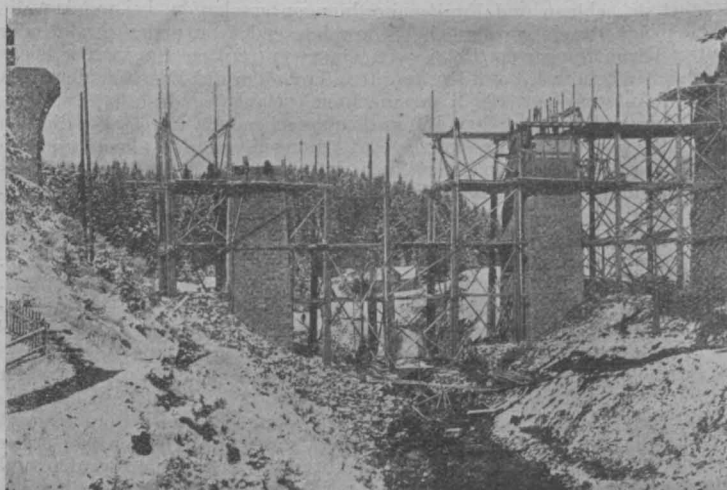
Bau des Montierungsgerüsts. Betonieren des nördlichen Pfeilers.
